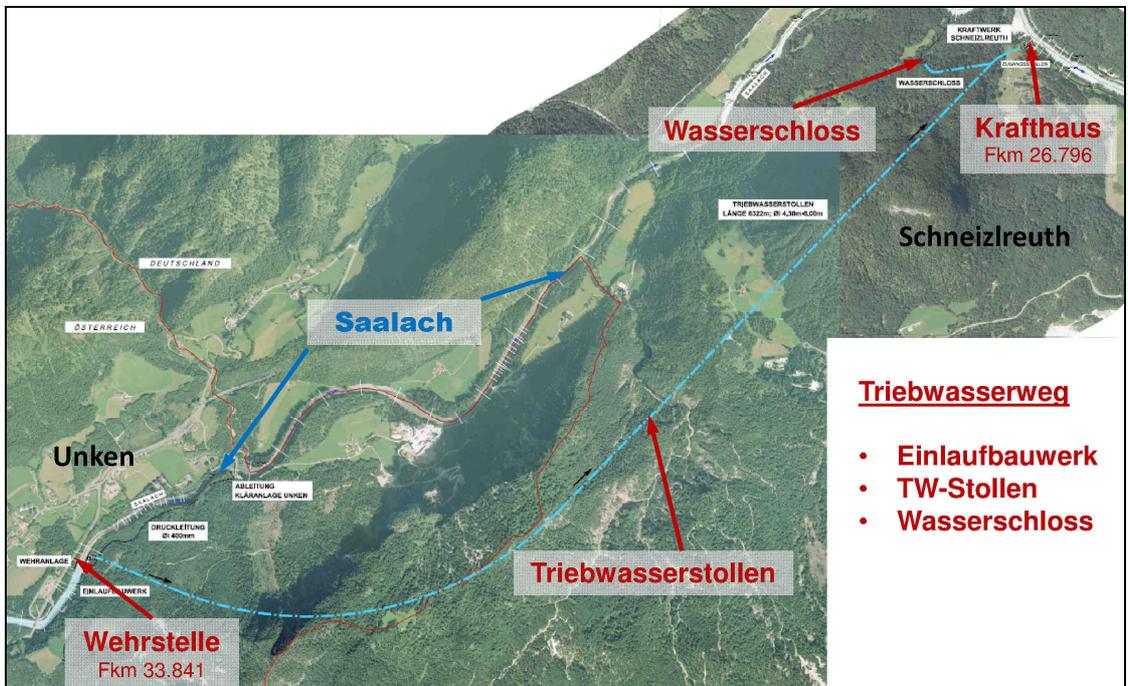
Übersichtslageplan des geplanten Vorhabens
